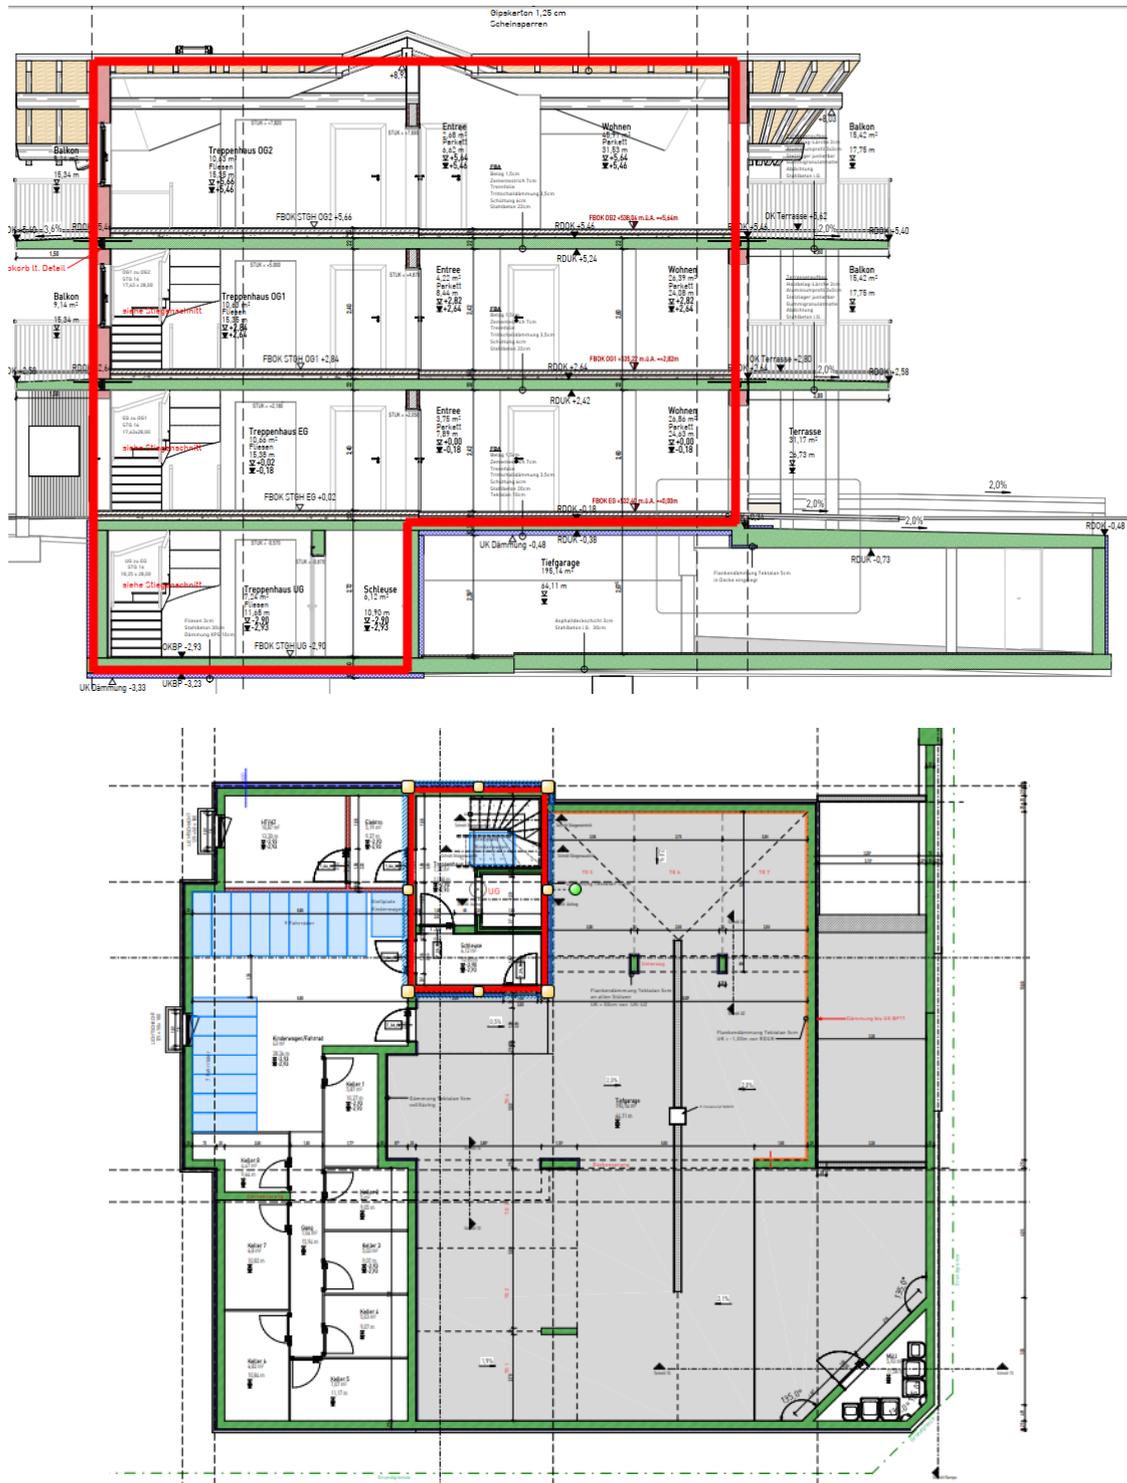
Schnitt + Grundriss UG "Thermische Hülle"
